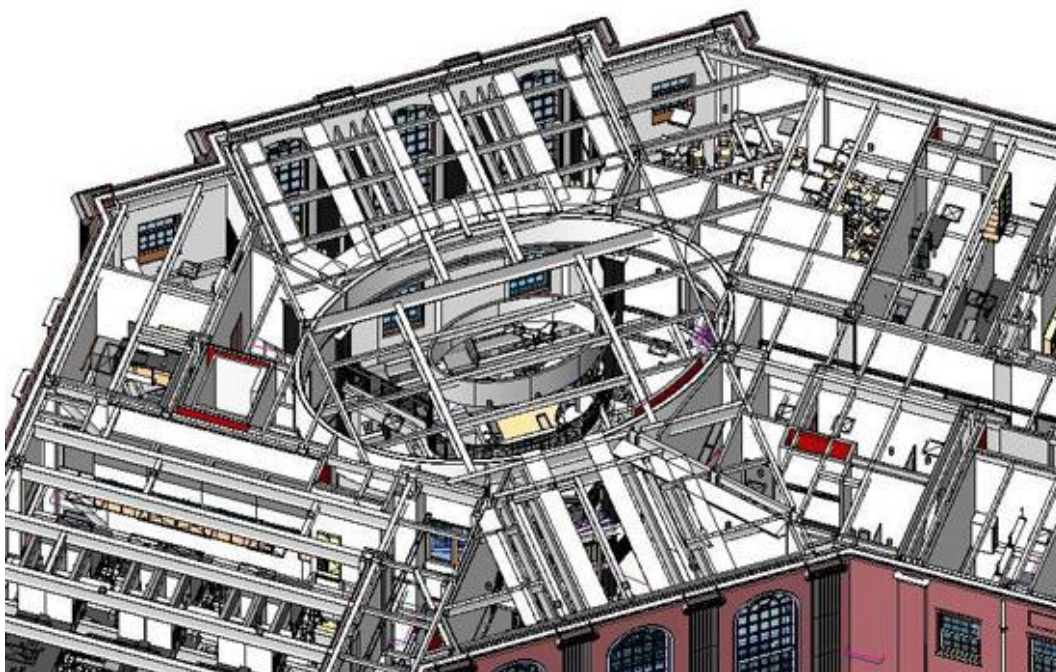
Model BIM molt detallat. © EYP Architects
